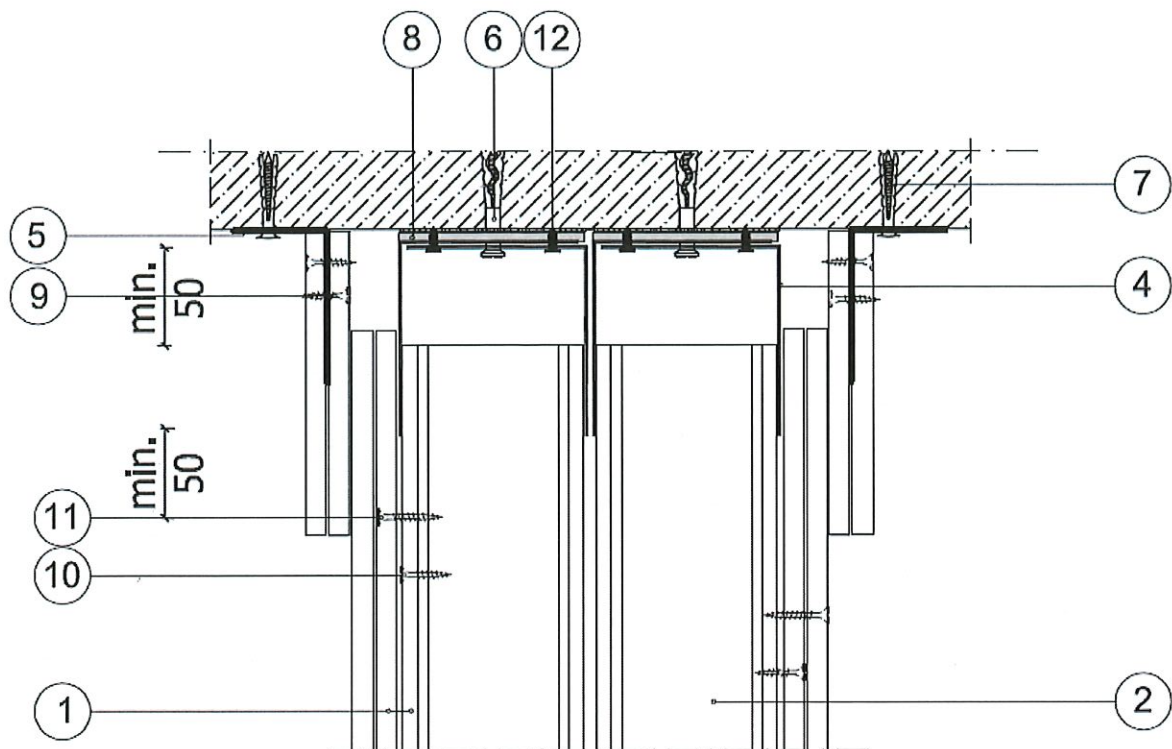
przekrój pionowy .Połączenie teleskopowe ściany dla ugięcia stropu lub dachu do 50 mm ze stropem lub dachem
